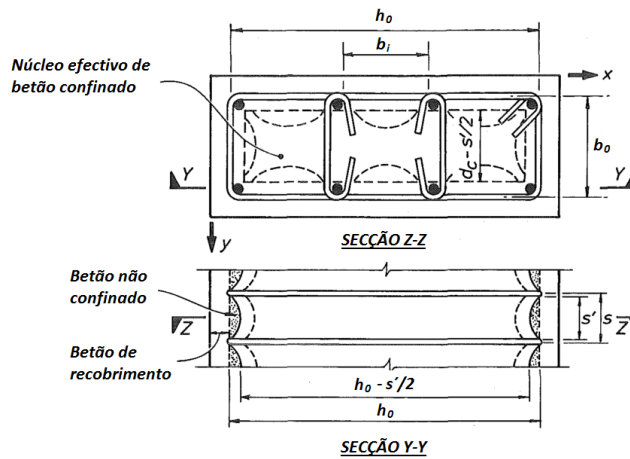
Núcleo efectivo de betão confinado para secções rectangulares (adaptado de [14]).
